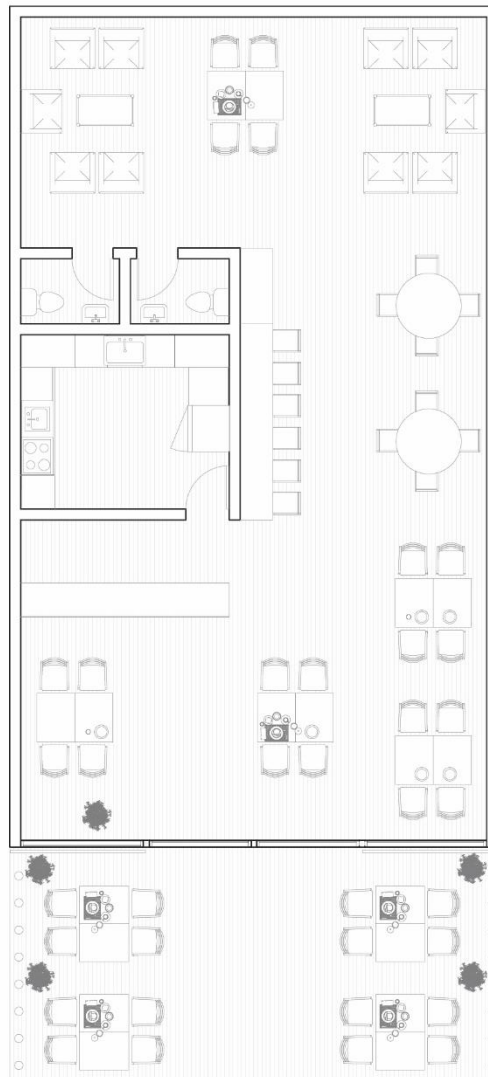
Distribución Restaurante – Planta Picaditas 1000
